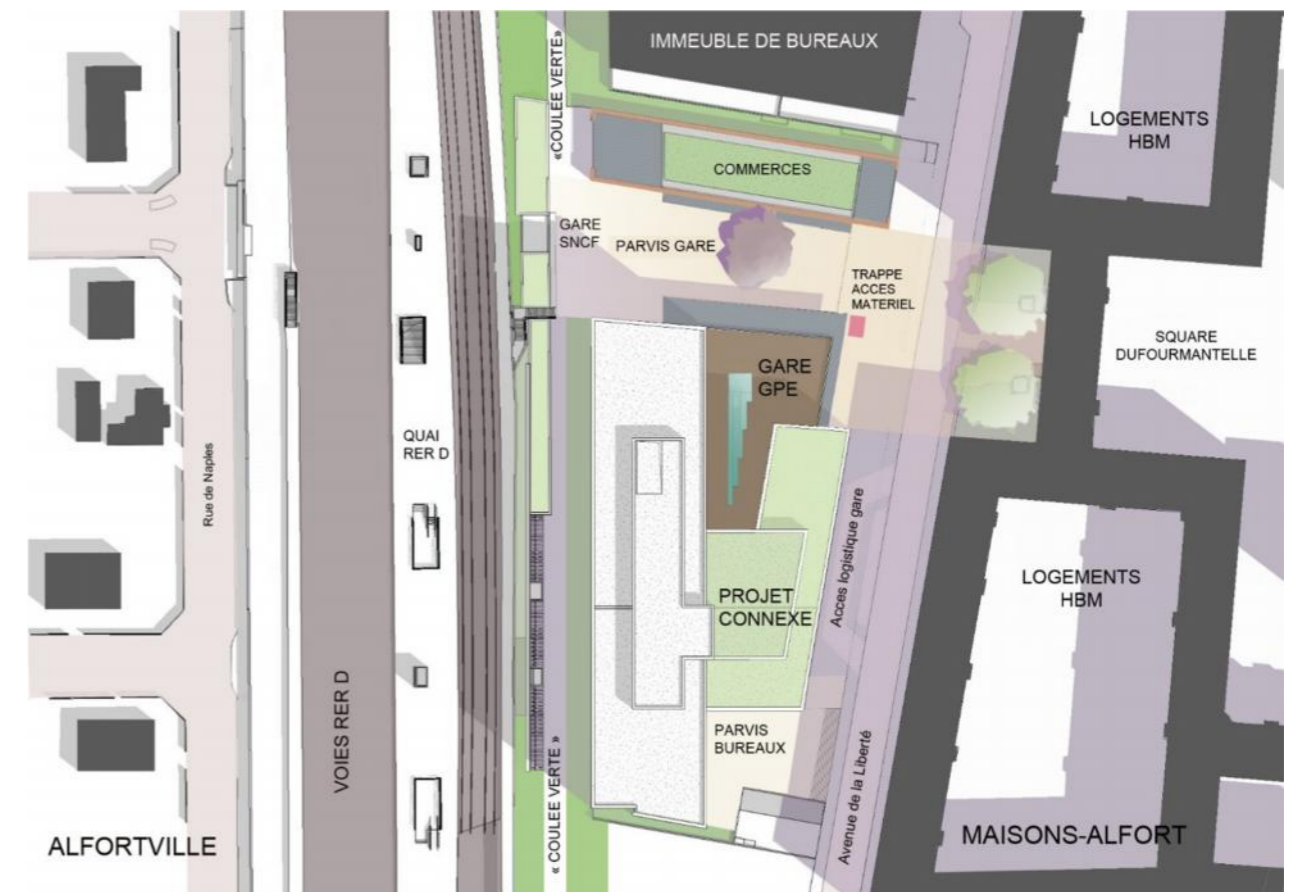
Plan masse de la gare (VPA 23/12/2014)
